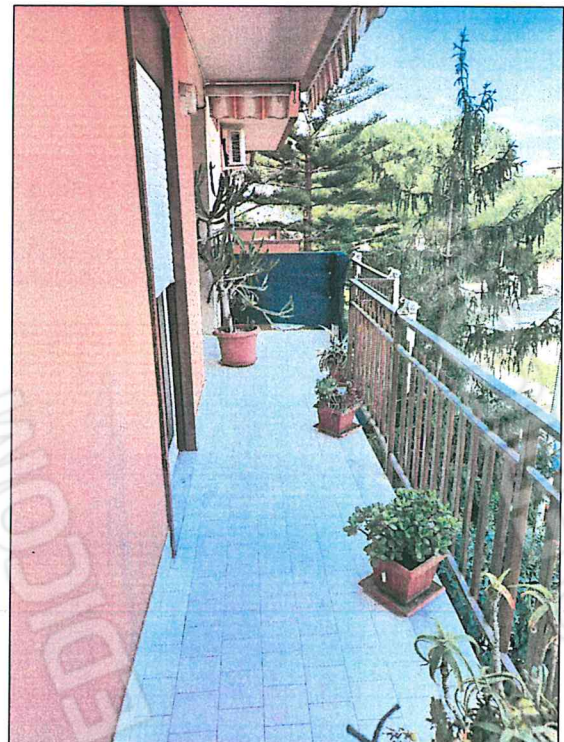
Foto dei balconi rispettivamente lato soggiorno e lato cucina. I balconi sono pavimentati, il parapetto costituito da ringhiera in ferro e muretto e le solette dei ballatoi necessitano di manutenzione.
